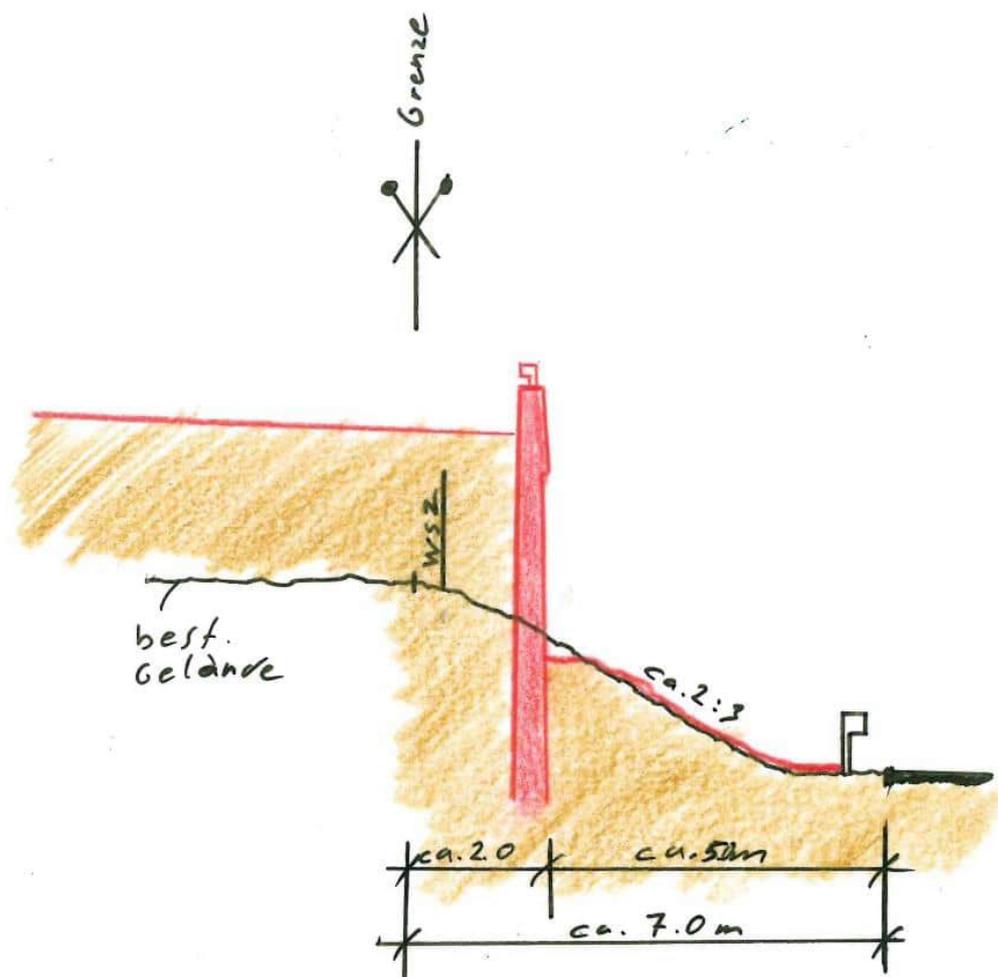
Schemaschnitt mit best. Gelände und neuer Stützmauer nach dem Bau der Ostumfahrung (Westseite)
